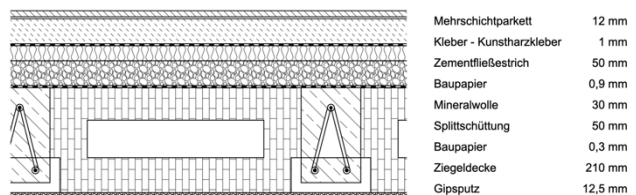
Detail Deckenaufbau Ziegel-Einhängendecke (maßstabslos)
